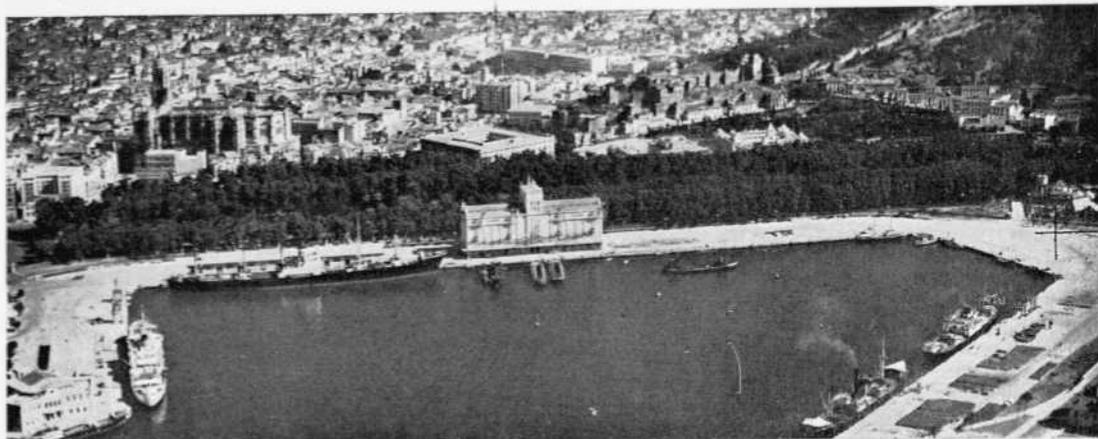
Silo de Málaga. Emplazamiento.
